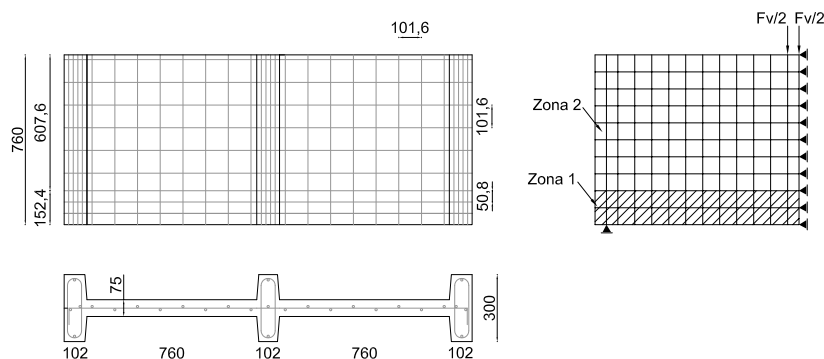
Geometria e detalhes das armaduras das paredes de concreto armado, Lefas et al. (1990)
